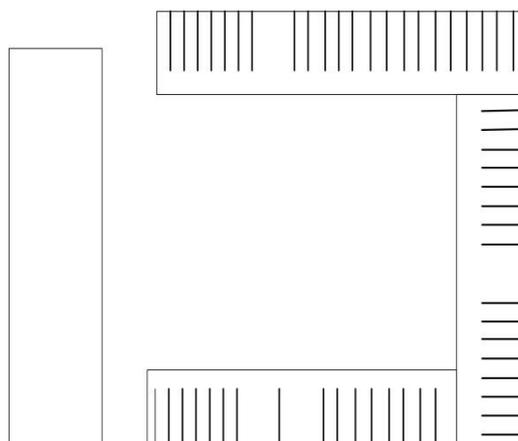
Estructura La Tourette. Elaboración Propia.
